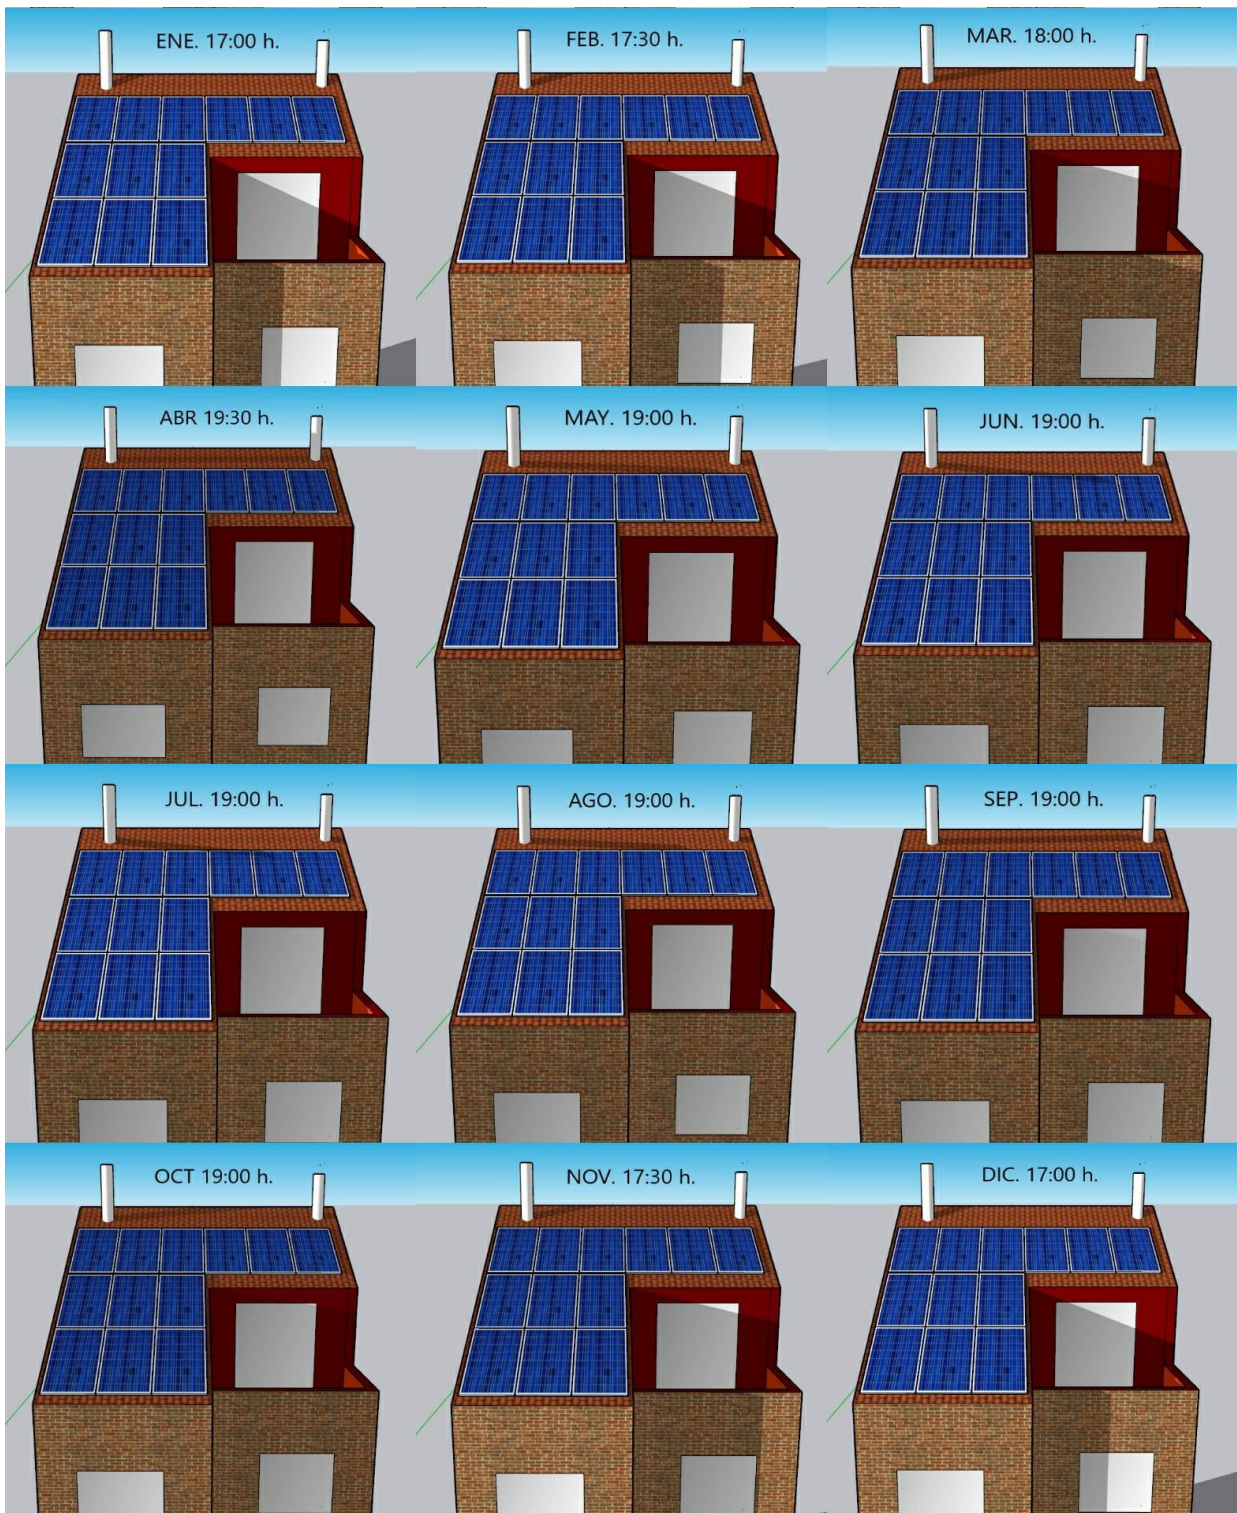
Sombras proyectadas por las chimeneas sobre el tejado al atardecer, con vista desde el suroeste. Elaboración propia.
